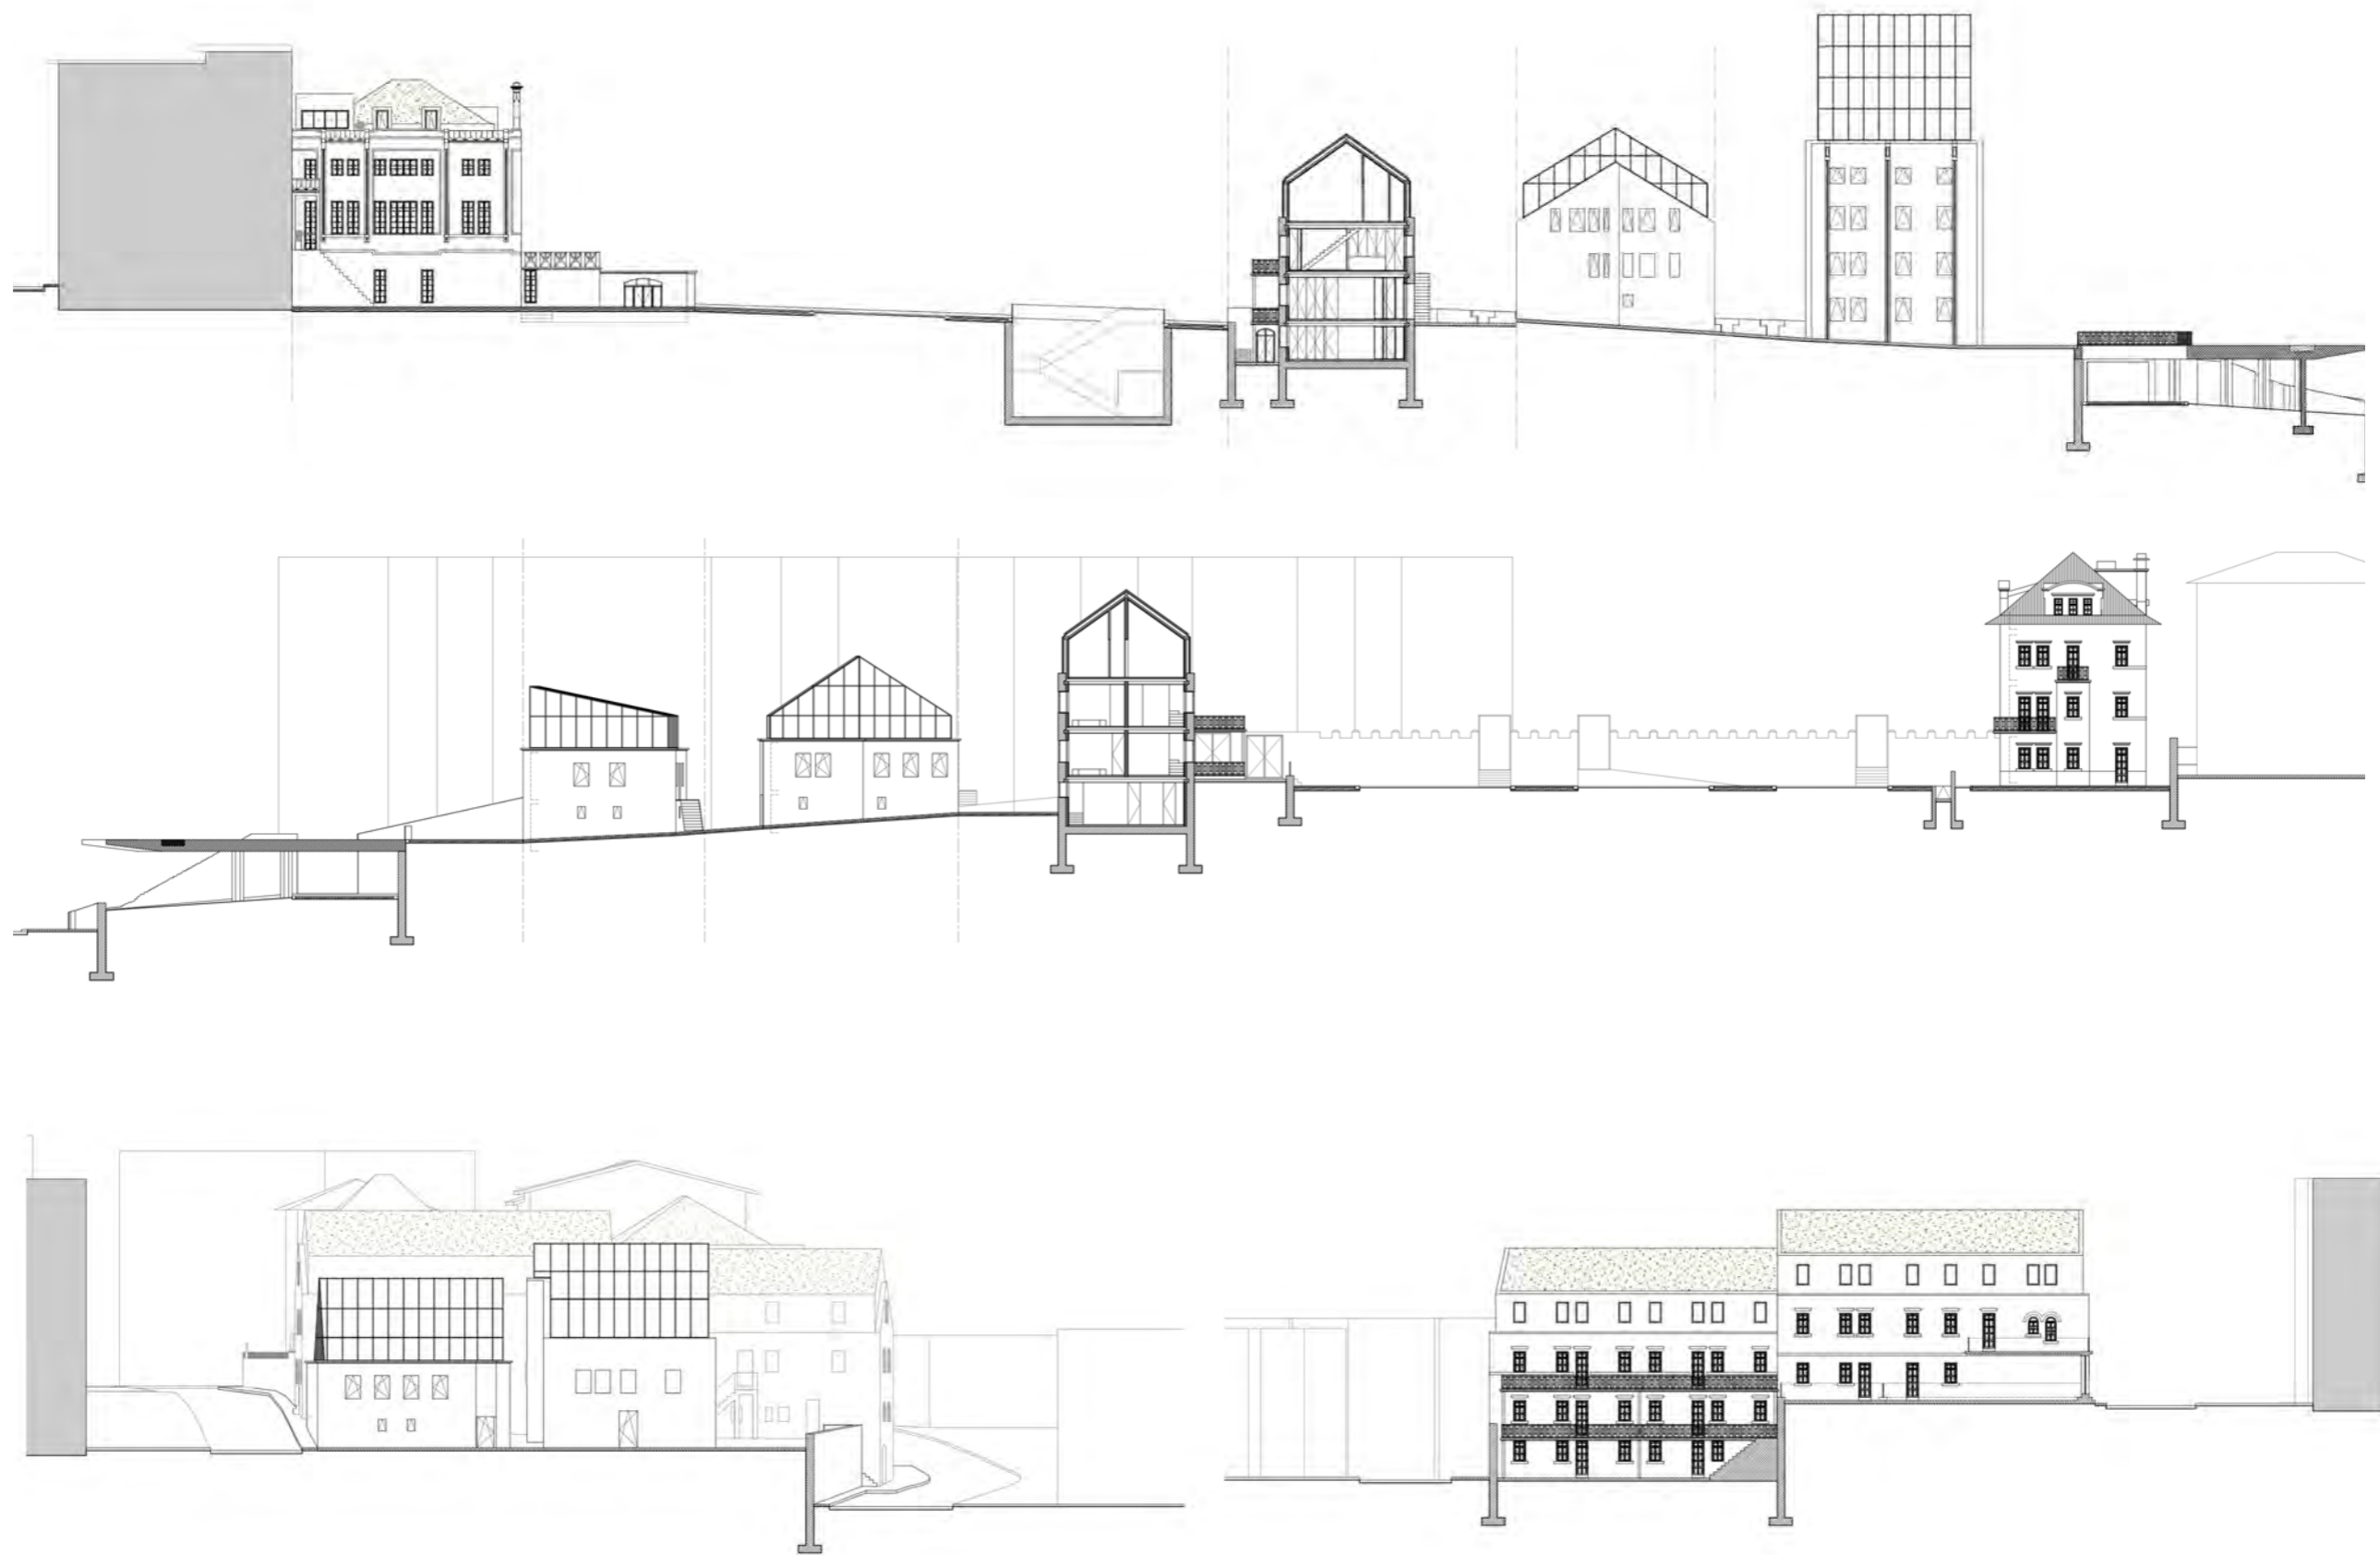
Cortes da proposta de intervenção no Bairro.
